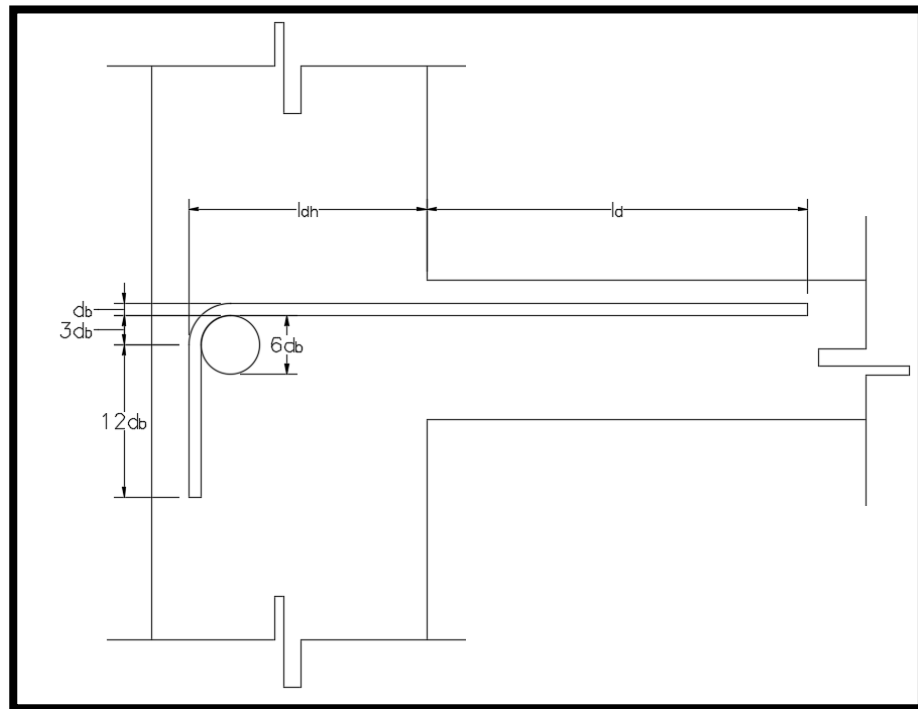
Longitud de bastones más el gancho de empotramiento.
